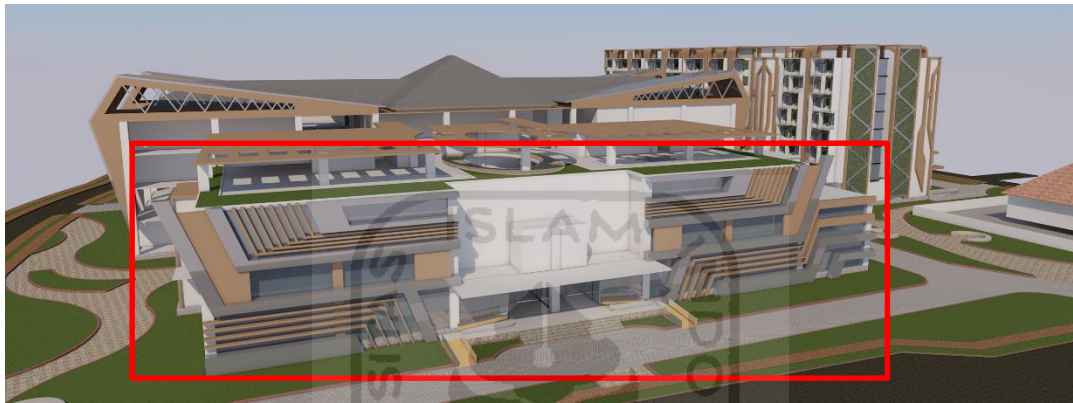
Penerapan Stacked Window pada Fasad Mall
